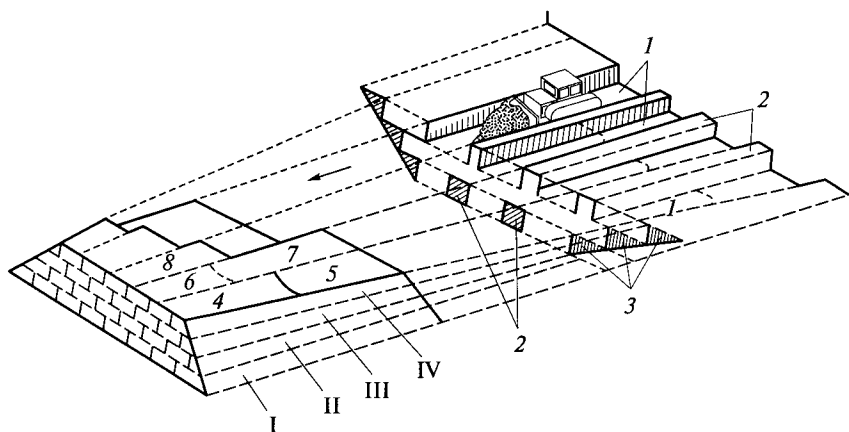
Разработка выемки бульдозером с перемещением грунта в насыпь:
